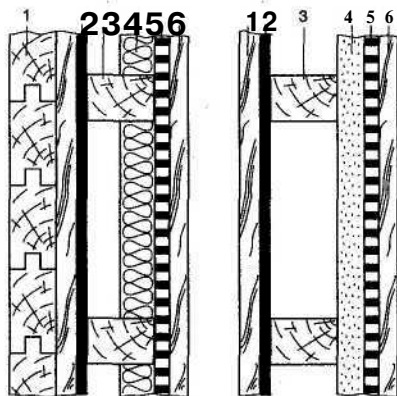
Конструкция панельных или каркасных стен банных помещений:
